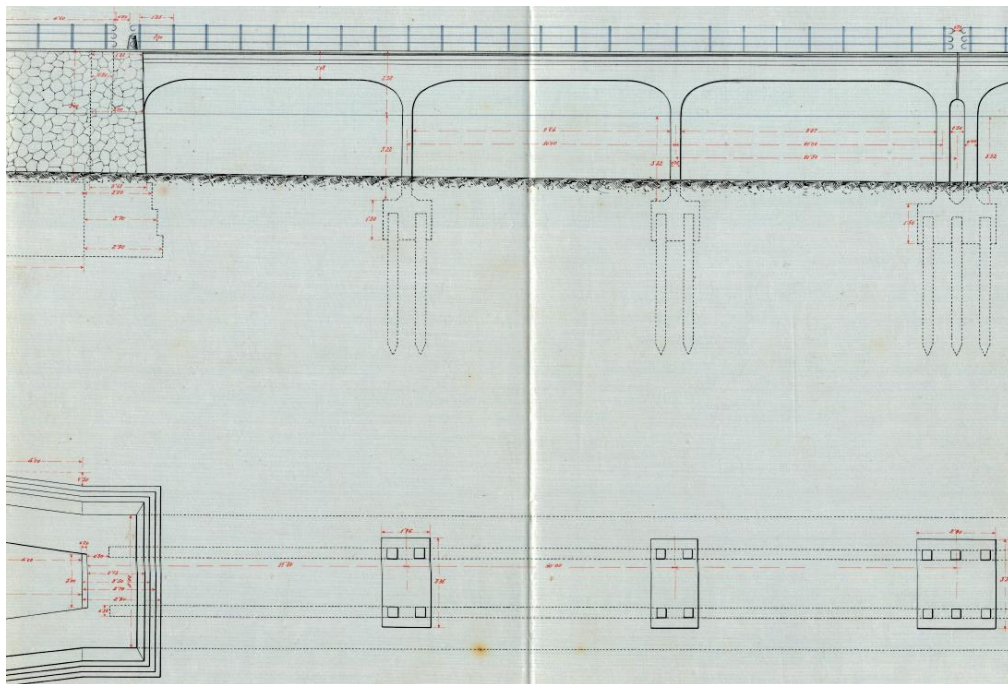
Primera estructuración del puente a base de pórticos [12]
